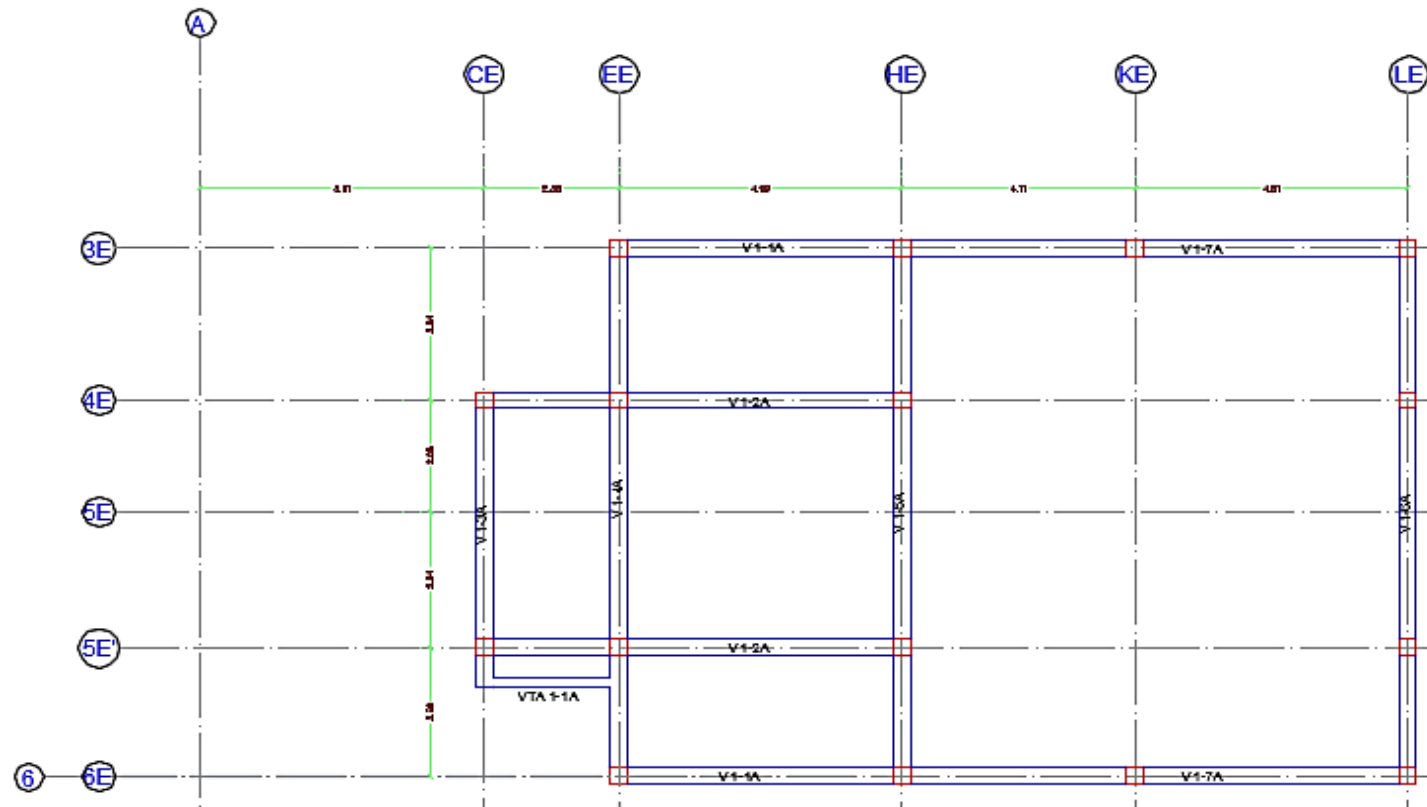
Plano estructural zona A, nivel 3.45 m. Fuente: Autor
